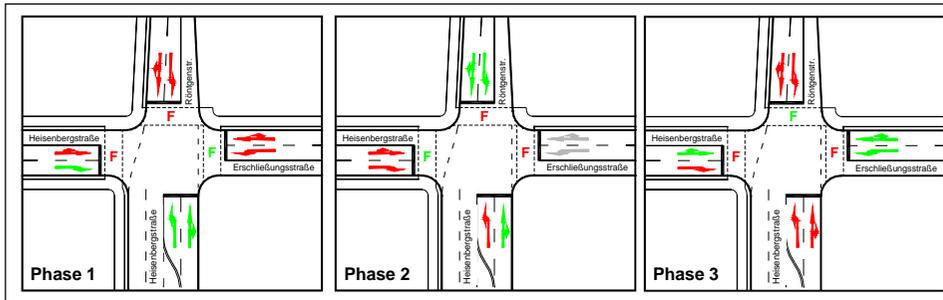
Phasenfolgeplan, Knoten Röntgenstraße / Heisenbergstraße
